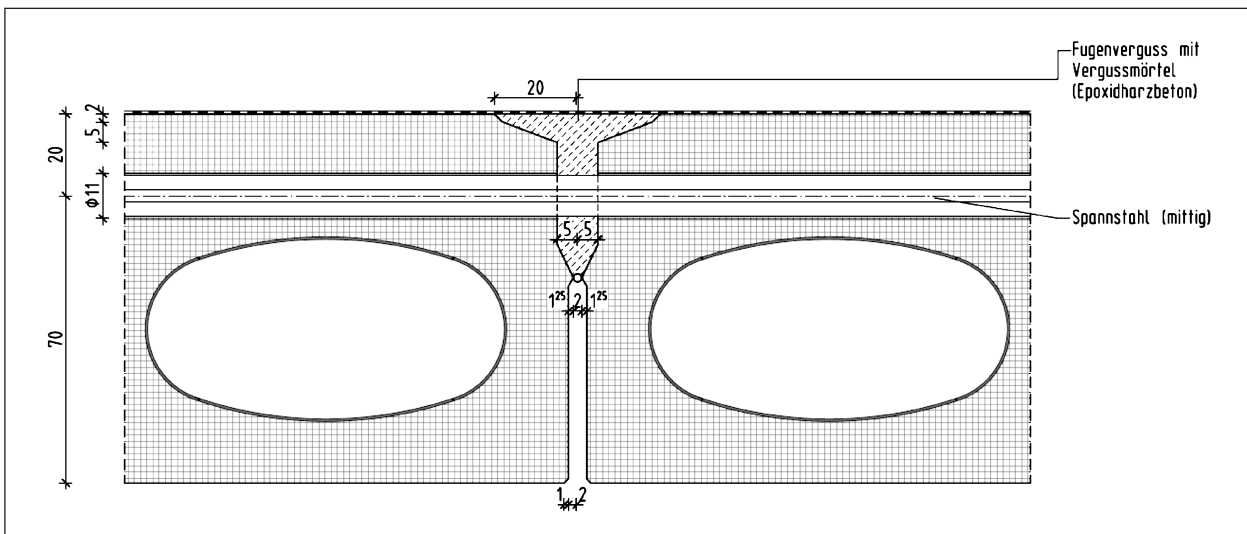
Detail – Fugenausbildung durch Mörtelverguss
